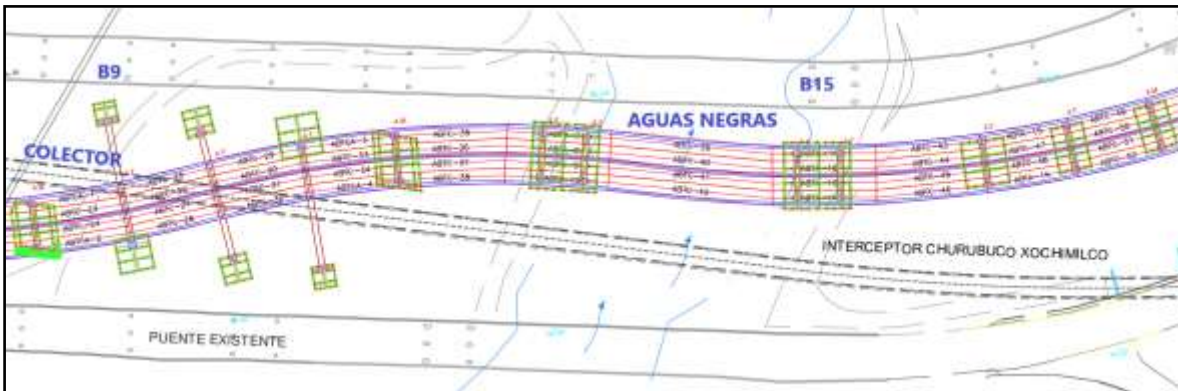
Planta de puente vehicular y colocación de traveses y cimentación parte 2.
